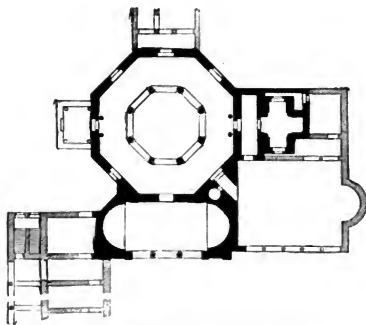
Baptisterium des Lateran. Grundriss.
